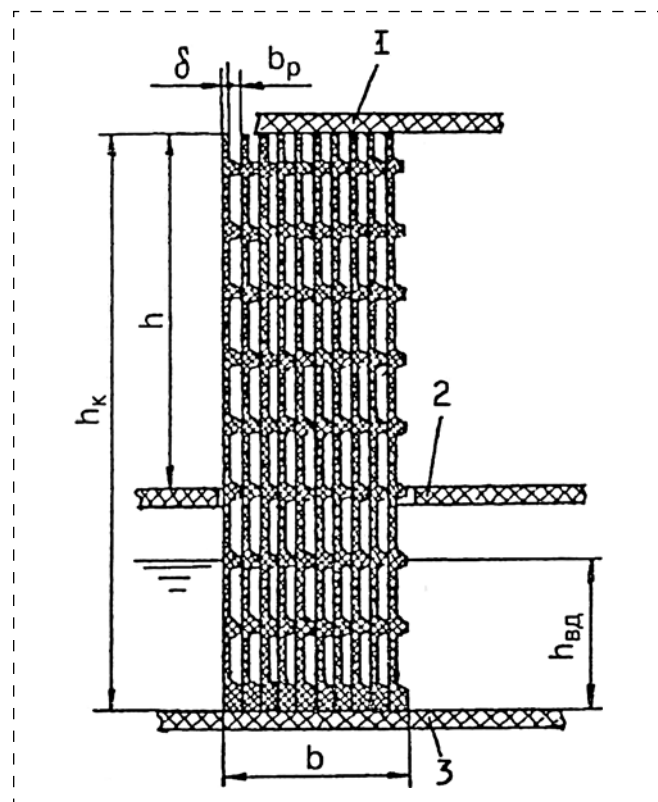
Схема устройства водоиспарительной насадки укладкой пластин из мипласта рядами:
